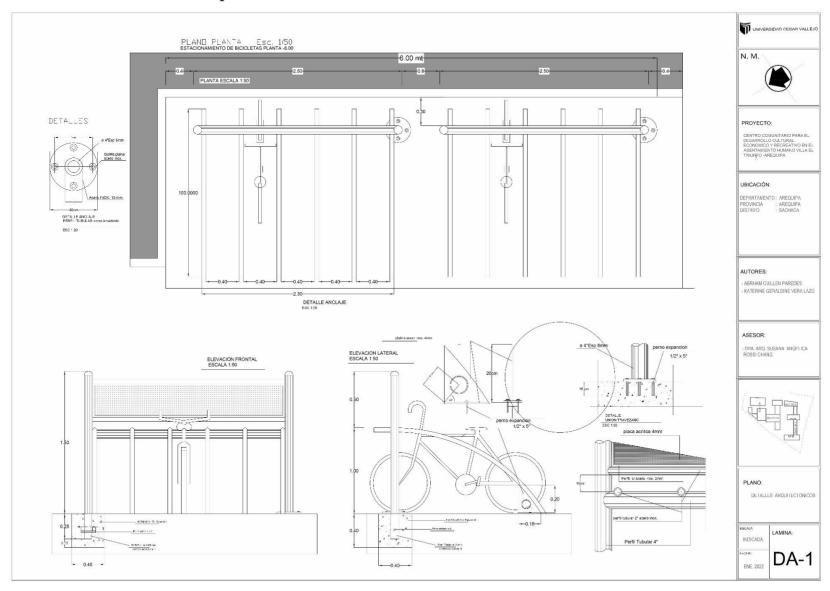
Plano de Detalles Arquitectónicos (Estacionamiento de bicicletas) - Elaboración propia
